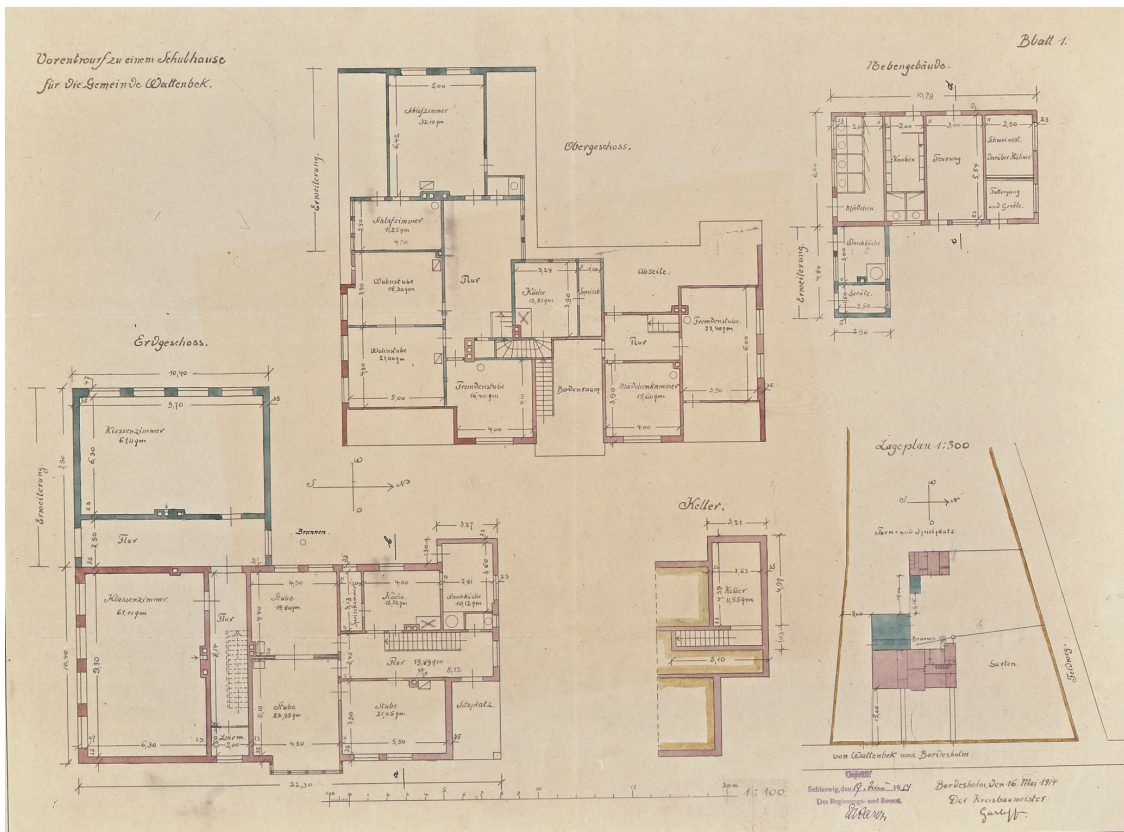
Garleffs Grundrissplan der Wattenbeker Schule, AAI 1743 PI, Erweiterungsbauten in Grün
